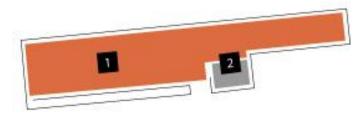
Planta esquemática del edificio anexo del museo de Arte Contemporáneo de Vigo. Fuente: Blog MARCO.
